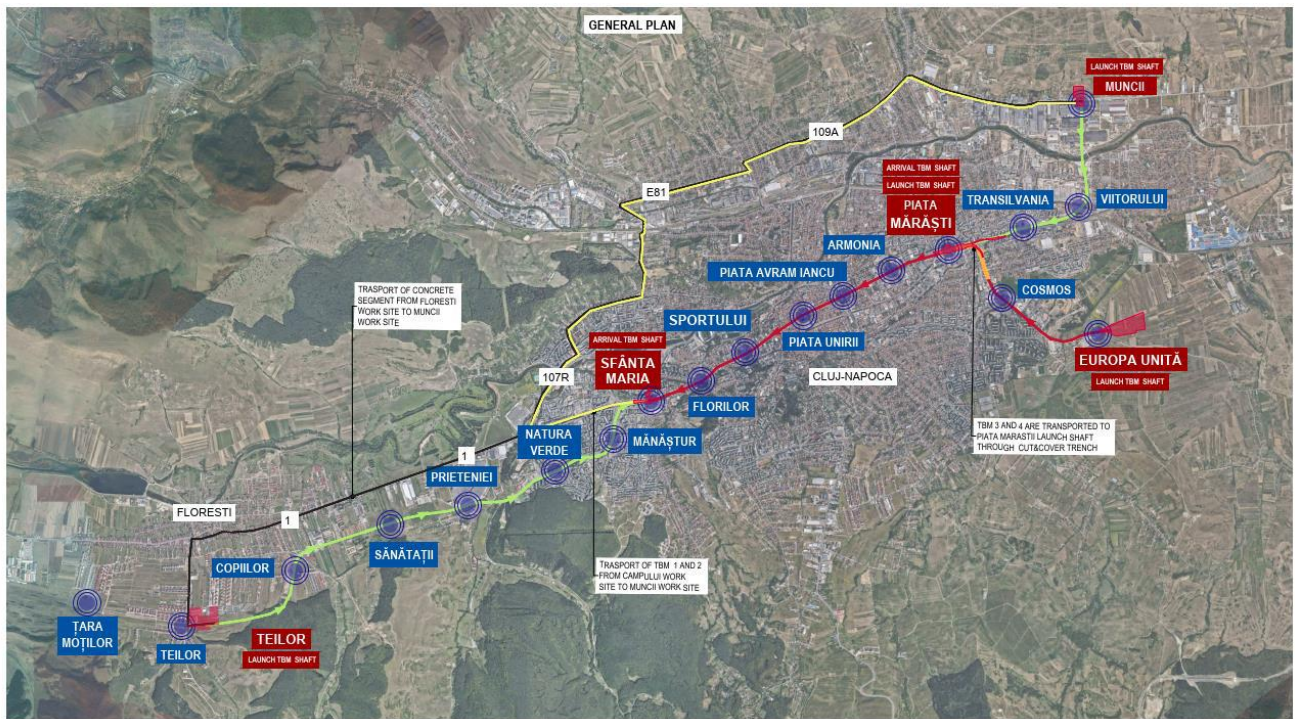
Plan general pentru amplasarea organizărilor de șantier
